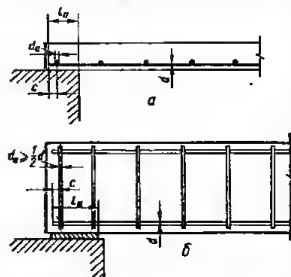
Анкеровка сварных арматурных сеток или каркасов на свободных опорах:
